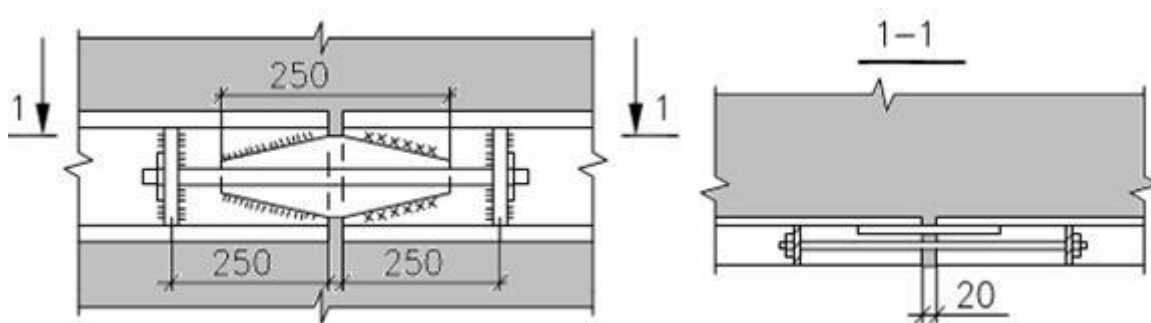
Натяжное устройство предварительно напряженного стального пояса из прокатных профилей
